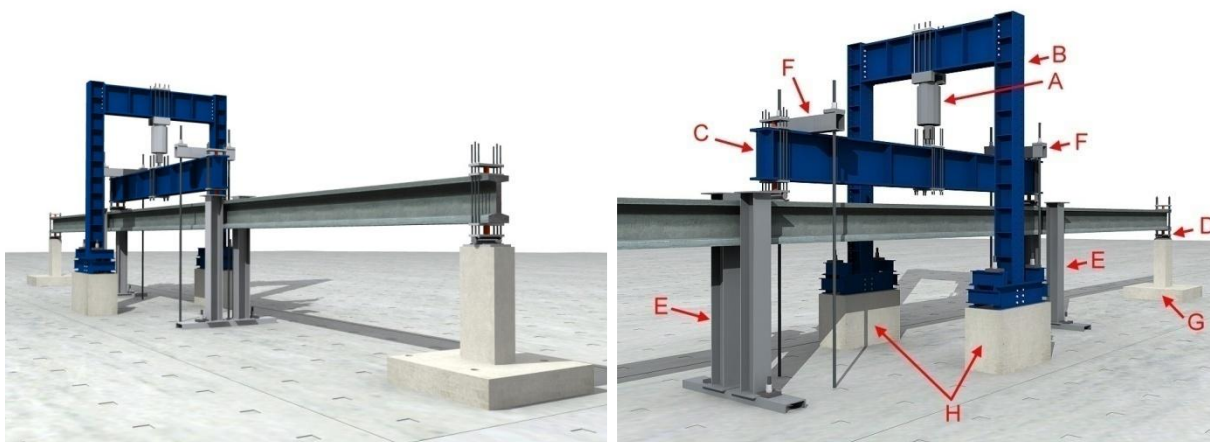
Simulação tridimensional da instalação de ensaio das vigas
